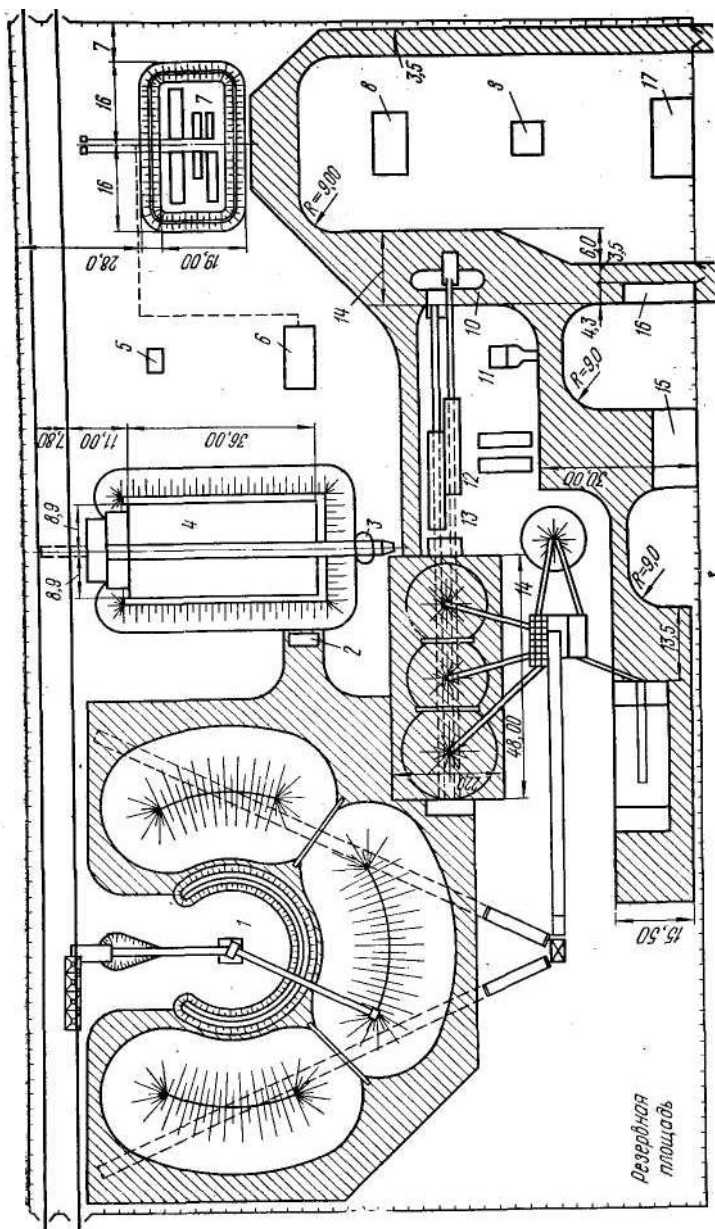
Схема генерального плану цементно-бетонного завода
